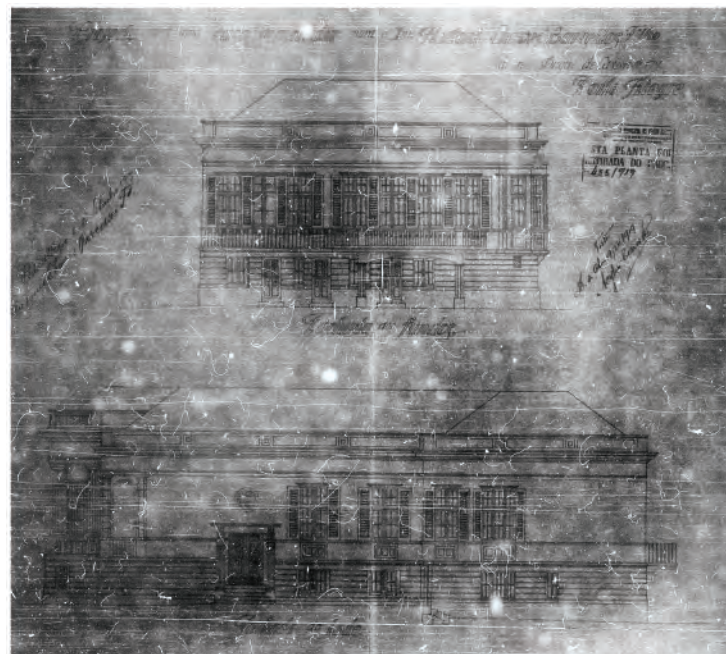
Fachada Sul (jardim) e fachada Oeste (divisa). FONTE: Acervo do Arquivo Público Municipal de Porto Alegre.
